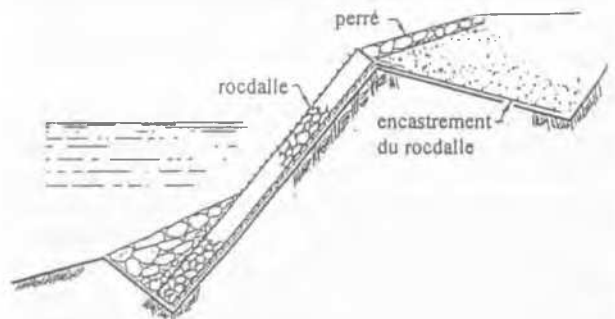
Rocdalle treillis-empierre-Coupe type
